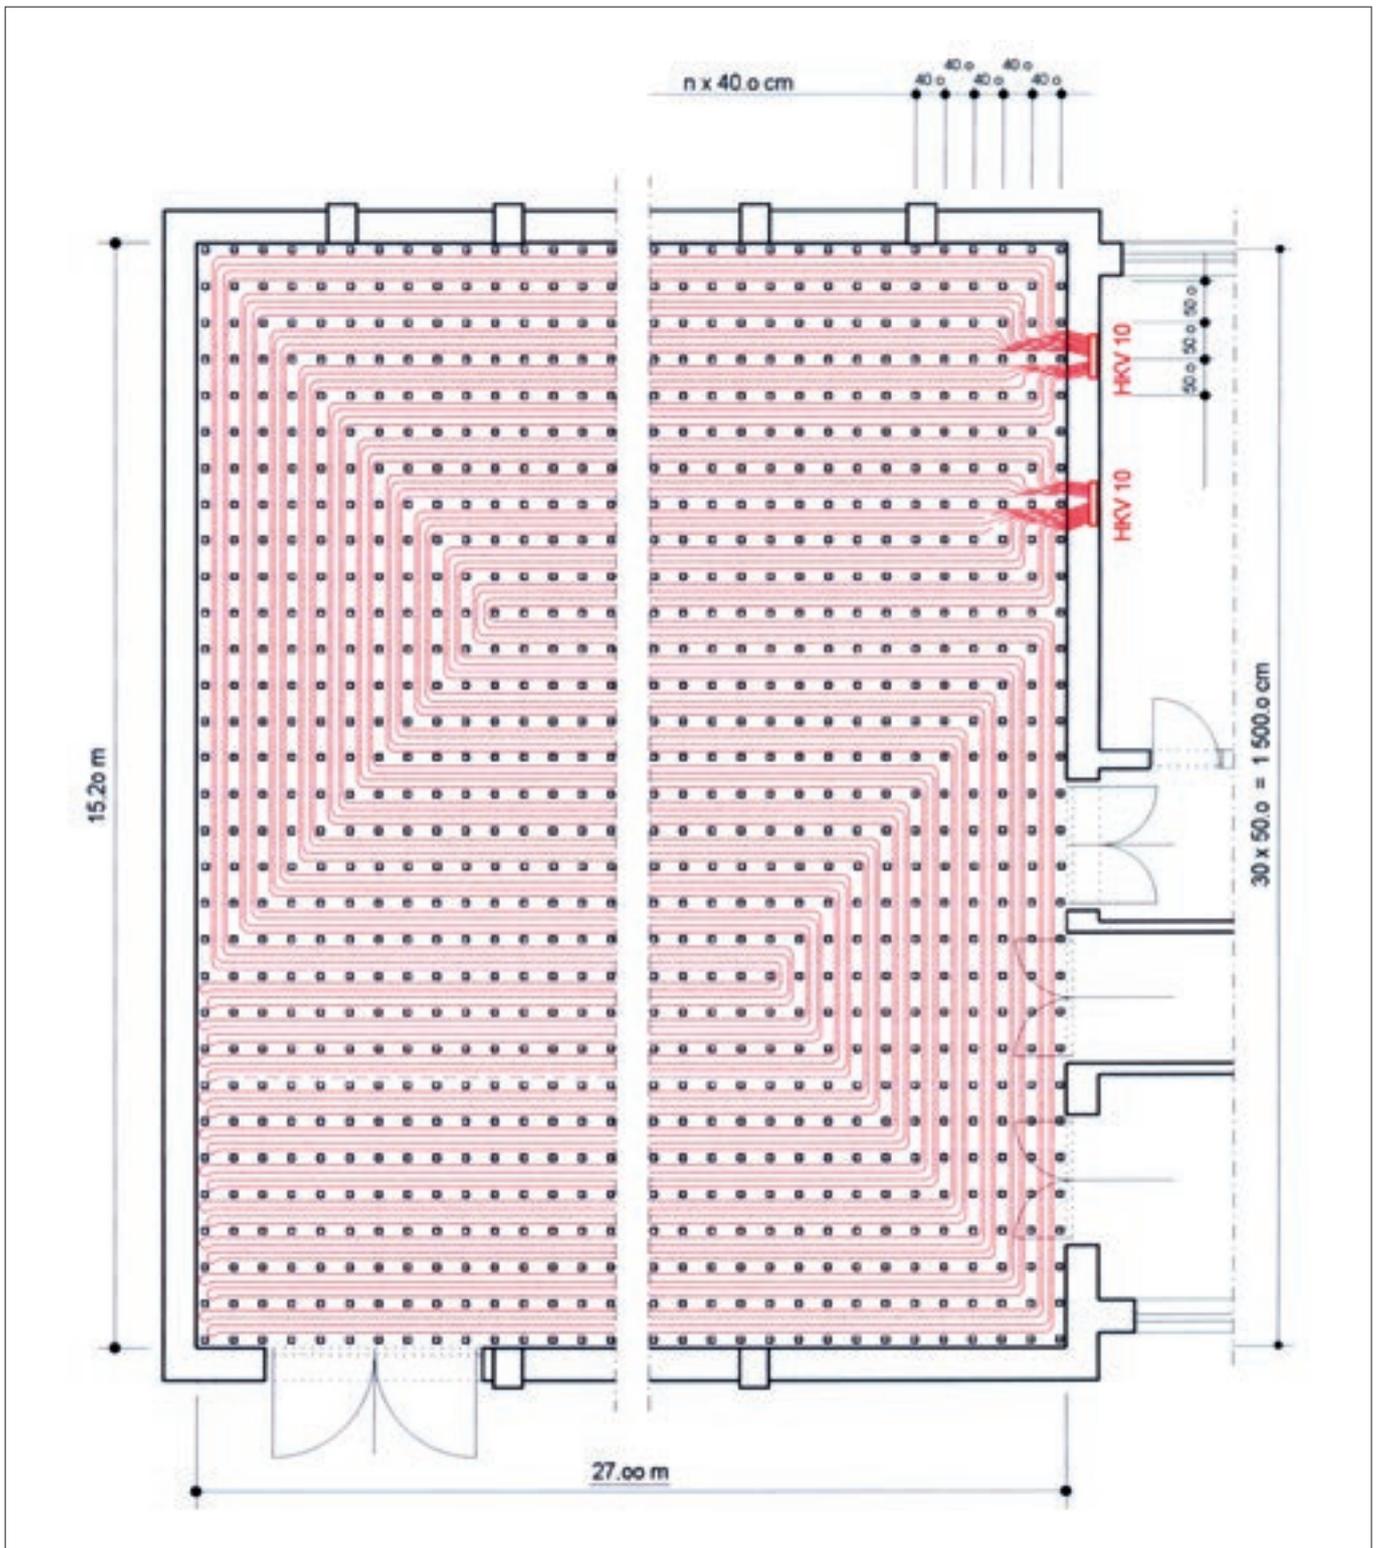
Rappresentazione schematica per il riscaldamento di pavimenti flettenti con collettore standard
